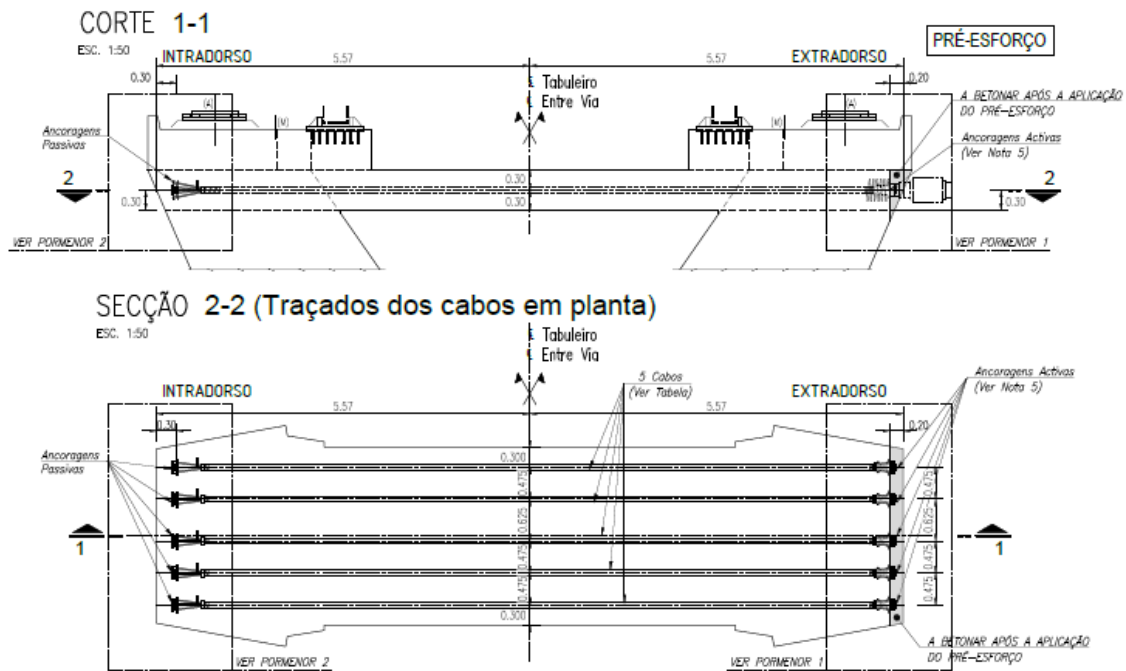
PT1 Pré-esforço e Aparelhos de Apoio
